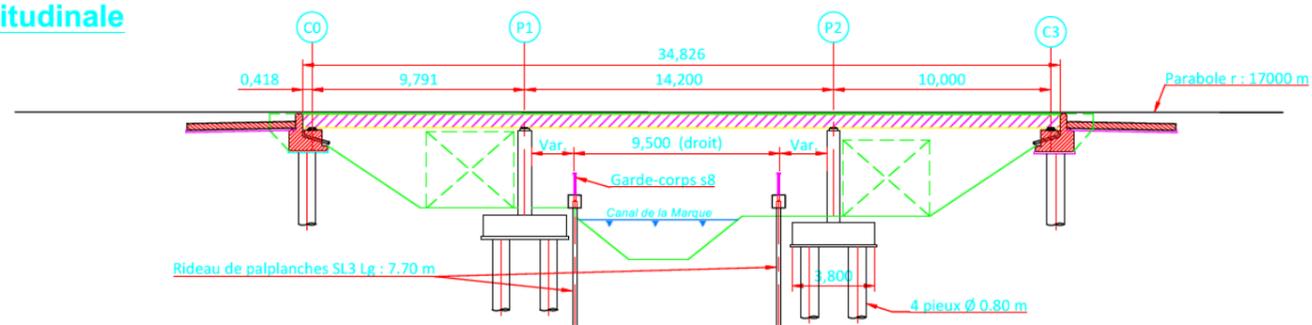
P12 – Vue en plan et coupe longitudinale de l'ouvrage existant
